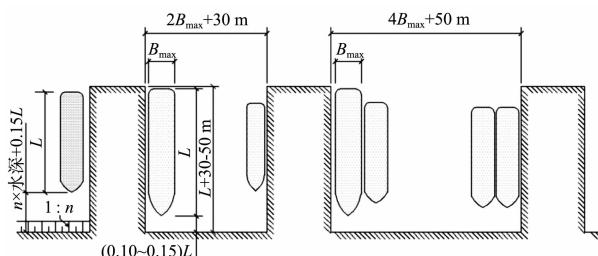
突堤间港池平面布置（港池同一侧布置 1 个泊位）
